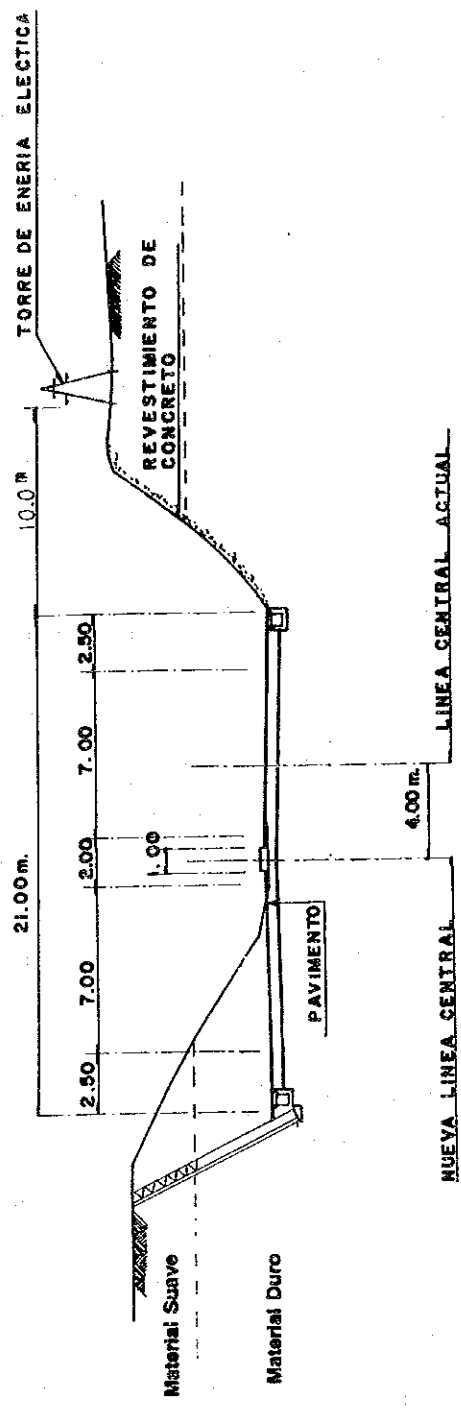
Detalle de Variante en Est. 0+490, Puente La Morita
